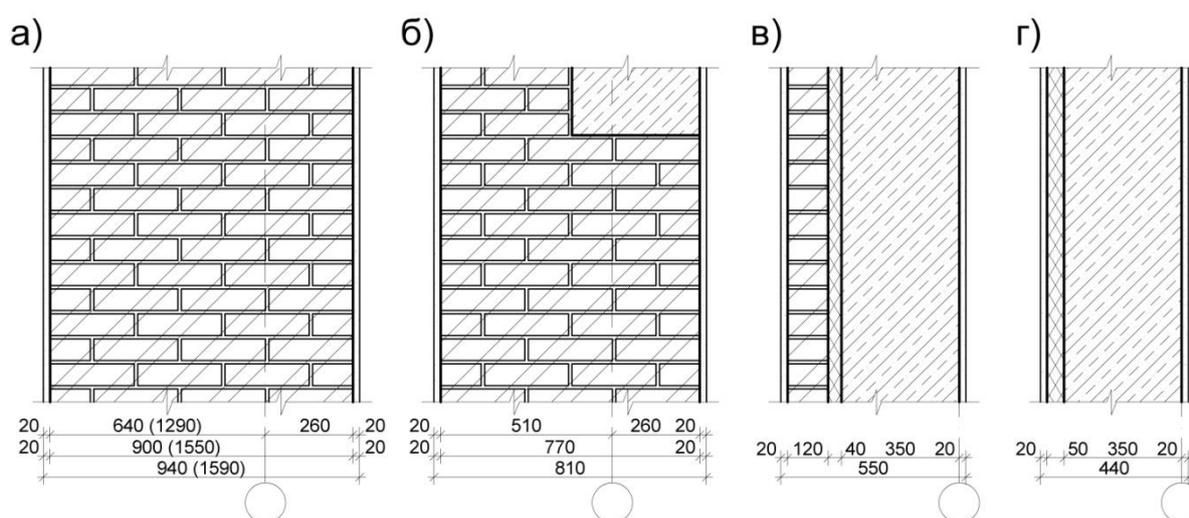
Варианты наружных стен зданий православных храмов, рассматриваемых в статье: а) кирпичных, традиционно применяемые; б) кирпичных, работающих совместно с элементами железобетонного каркаса; в), г) железобетонных для данного примера ориентировочного прочностного расчёта с облицовочным слоем из кирпича и штукатурки соответственно.
